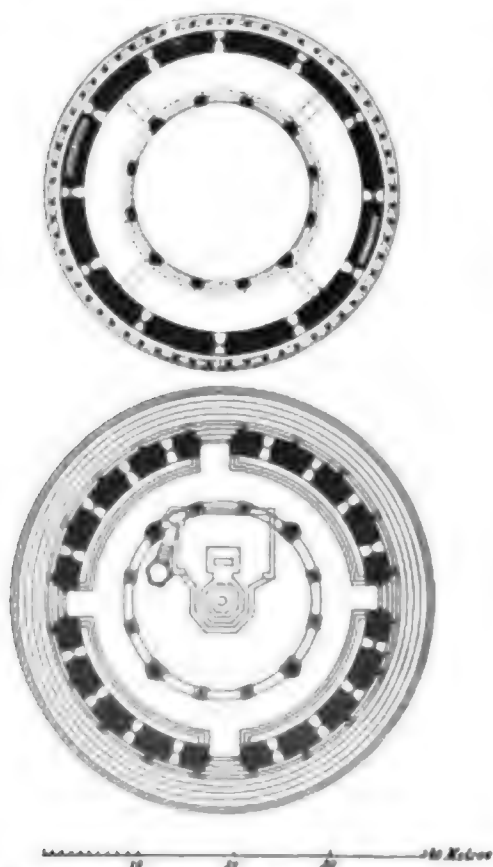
Planta del piso bajo y galería superior del baptisterio de Pisa.
